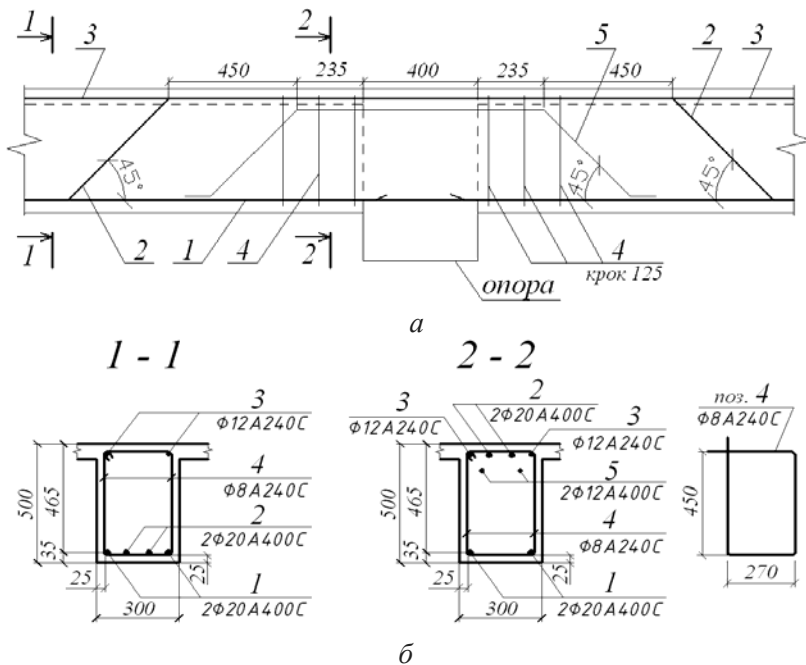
Армування балки поперечною вертикальною арматурою та відігнутими стержнями: а – вид збоку; б – перерізи 1 – 1; 2 – 2
